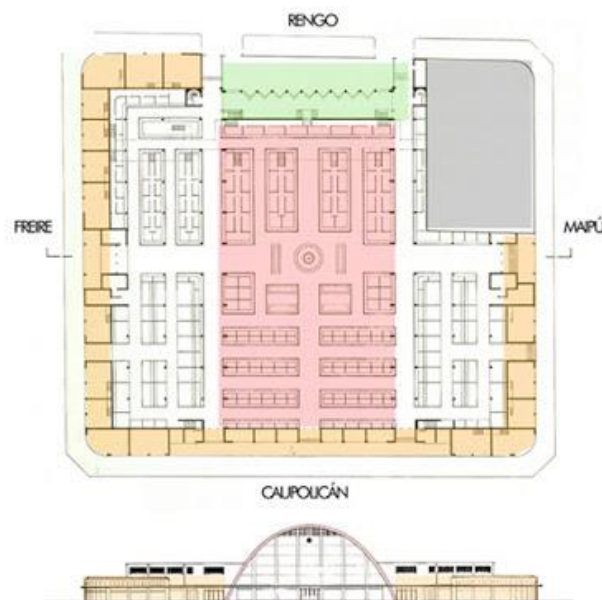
"Intervención sobre planimetría levantada por Mauricio Carrasco, publicada en la revista Arquitecturas del Sur n° 22, pág. 15, Archivo de Arquitectura Universidad del Bío Bío." (L.Darmendrail 2012)
